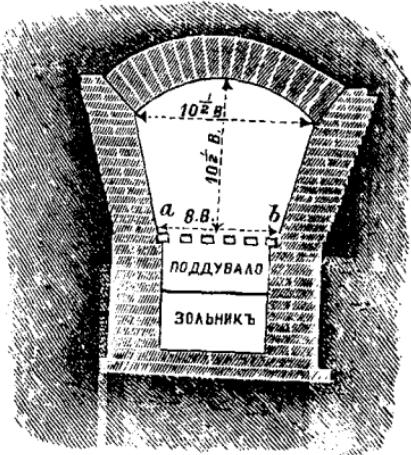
Поперечный разрѣзъ точки для дымового отопления.
